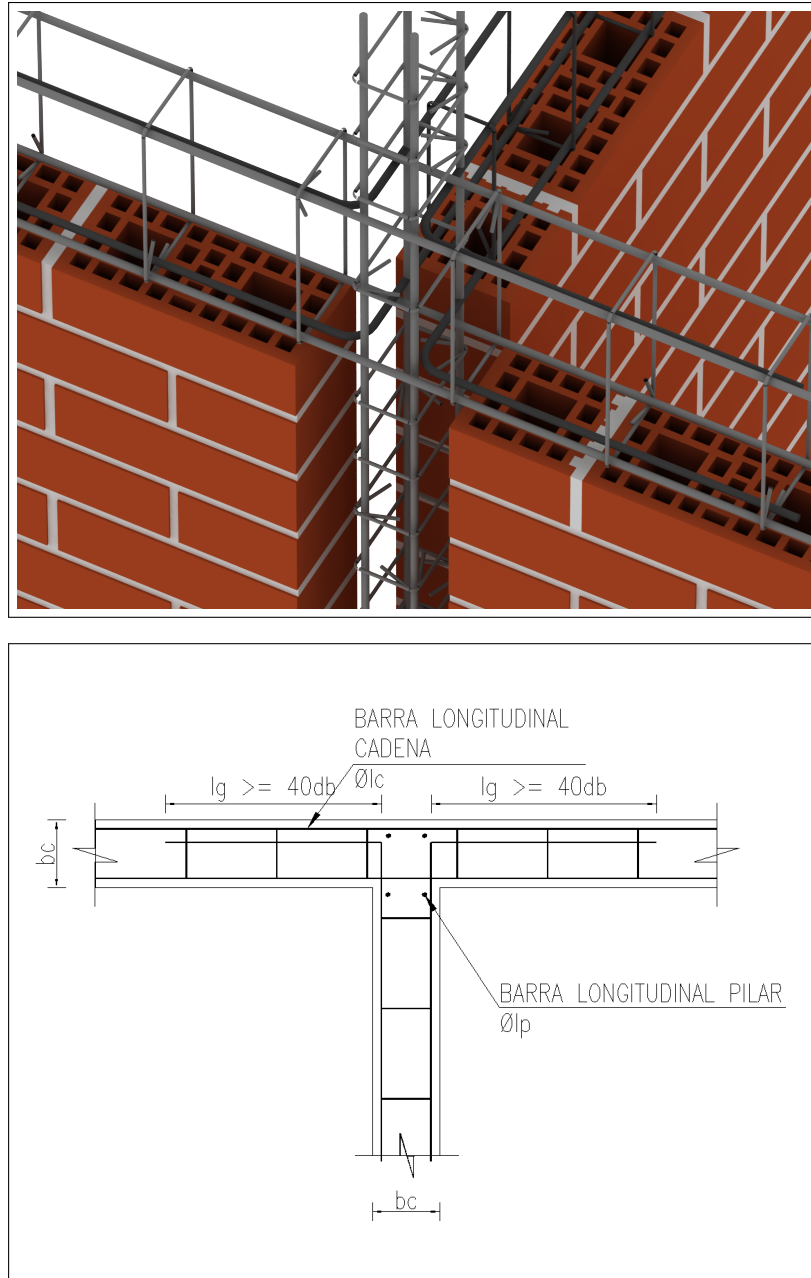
Detalle de barras longitudinales de cadenas de confinamiento en encuentro de muros en T. Caso A
